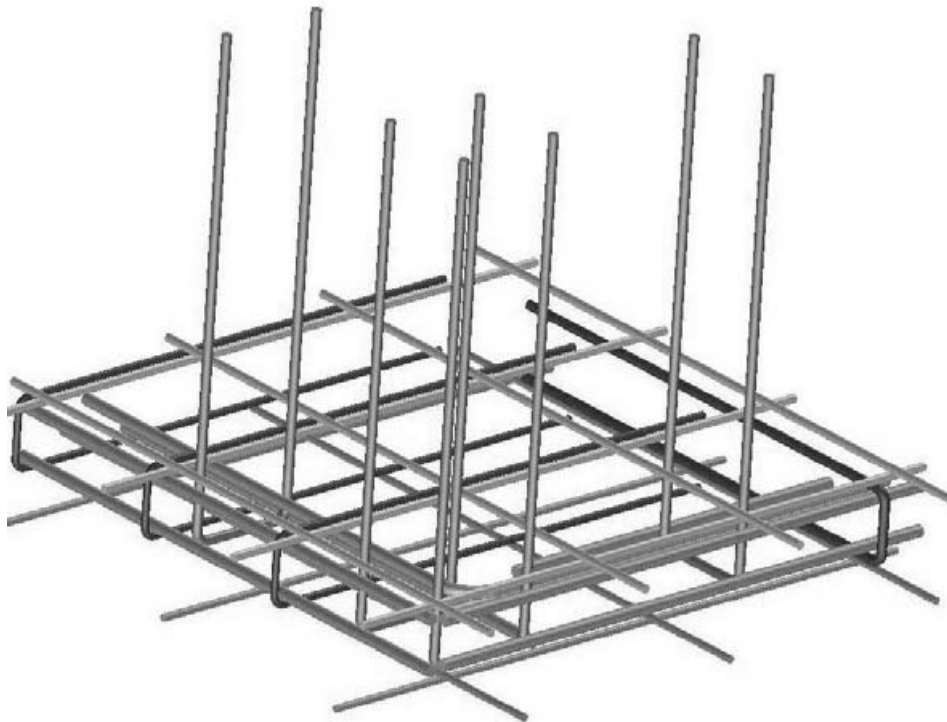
Vue 3D du ferrailage du radier et des armatures en attente
